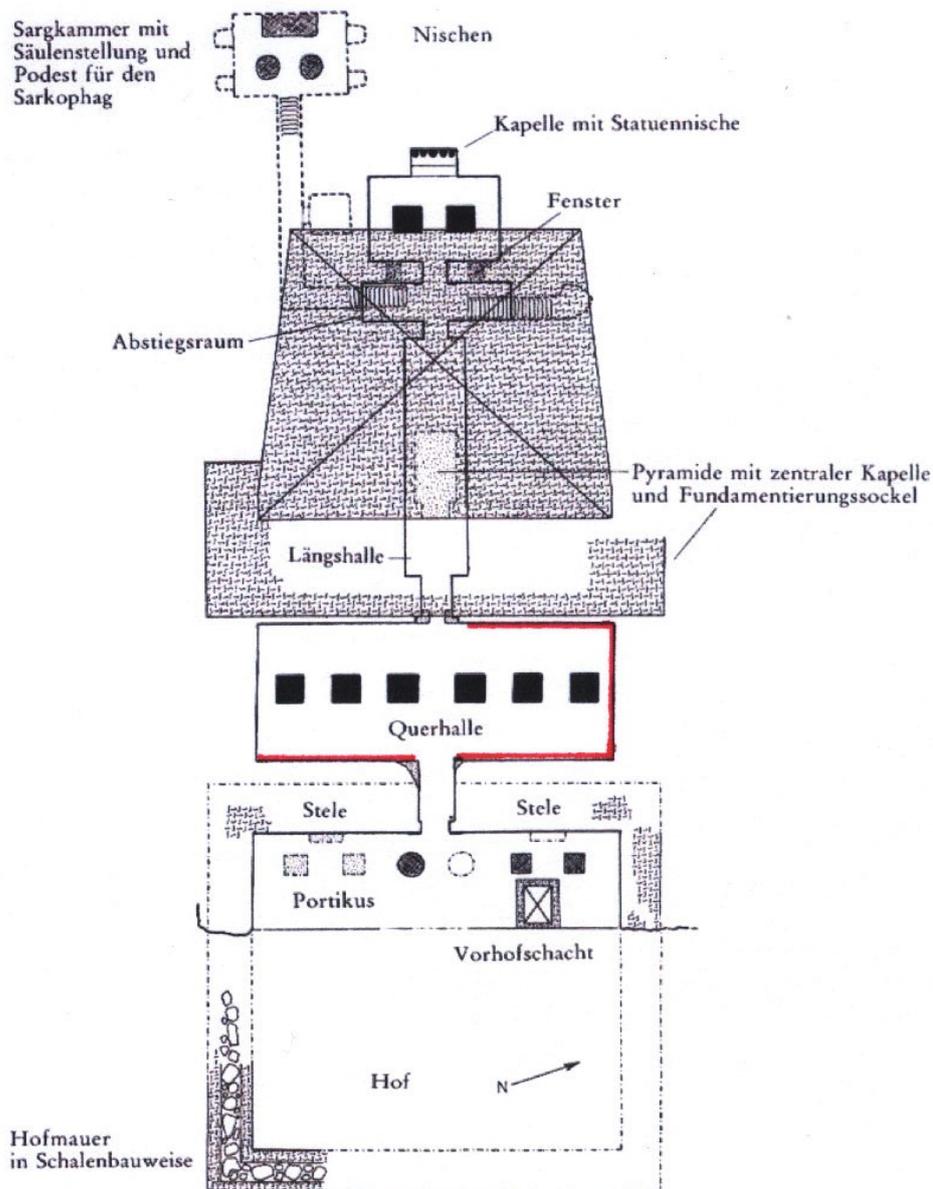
Grundriss von -162-, Grab des Parennefer.
